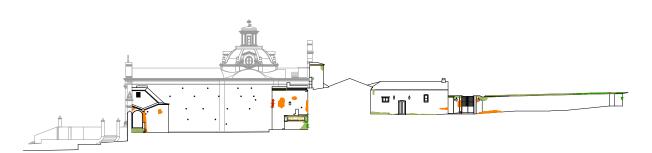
Relevamiento de lesiones - Fachada interna Norte
